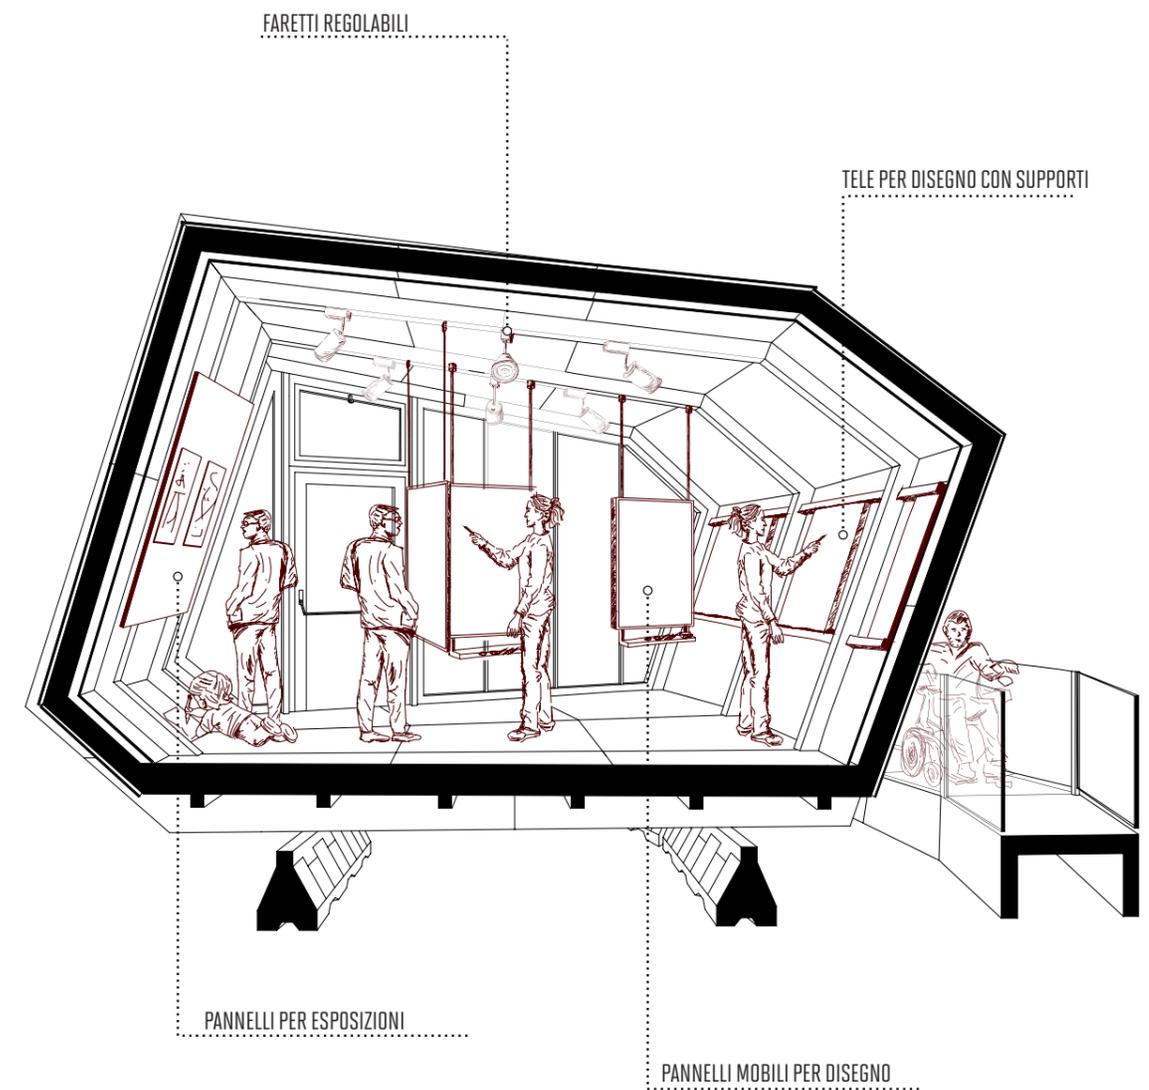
SEZIONE PROSPETTICA DEL BOX
